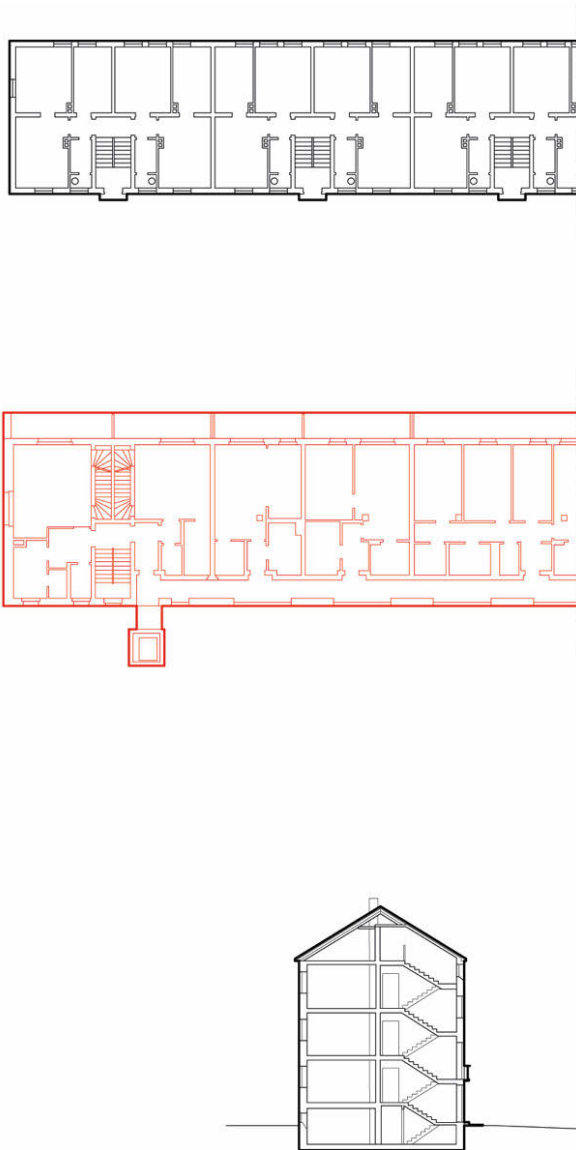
Grundrisse & Schnitte Bestand – Aufstockung 1, Attenkoferstraße
